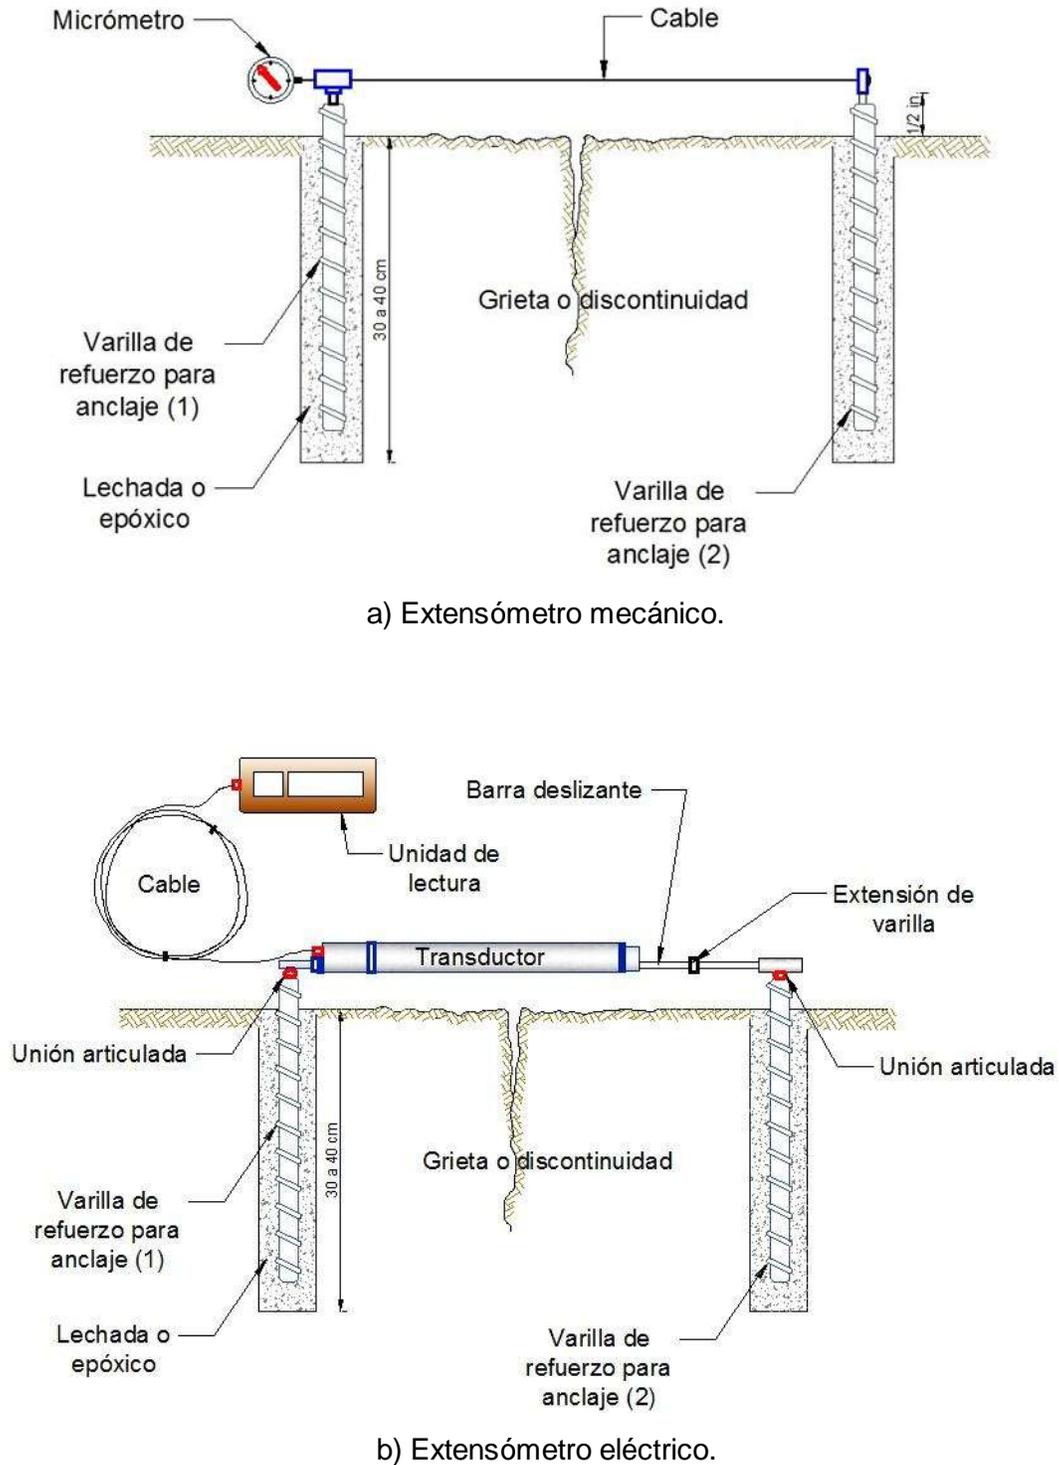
FIGURA. Partes de un extensómetro externo de juntas y grietas.
